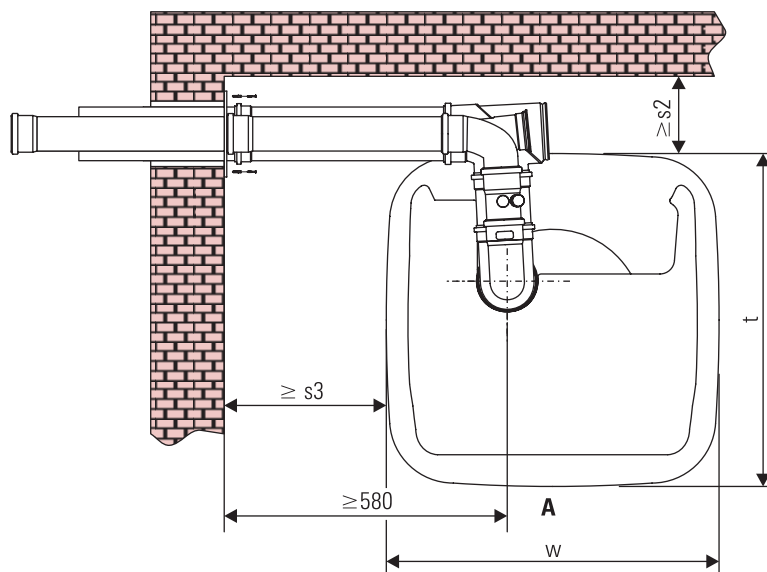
Vista dall'alto ROTEX GSU raccordo scarico fumi dal basso con set H (vedere sezione 3.5.3)
